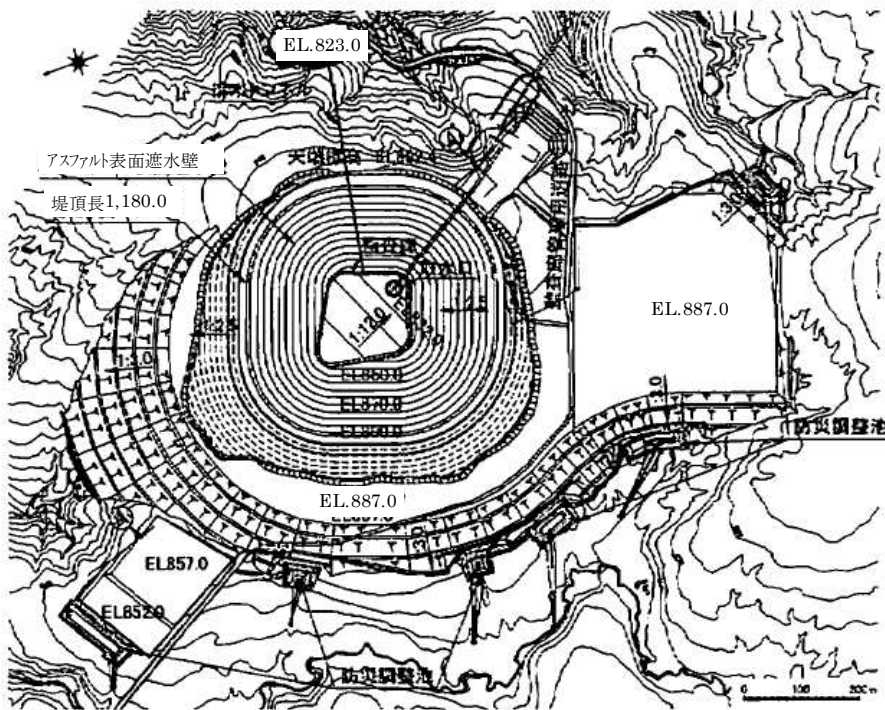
京極発電所上部調整池平面図 (文献 26)に一部加筆)
